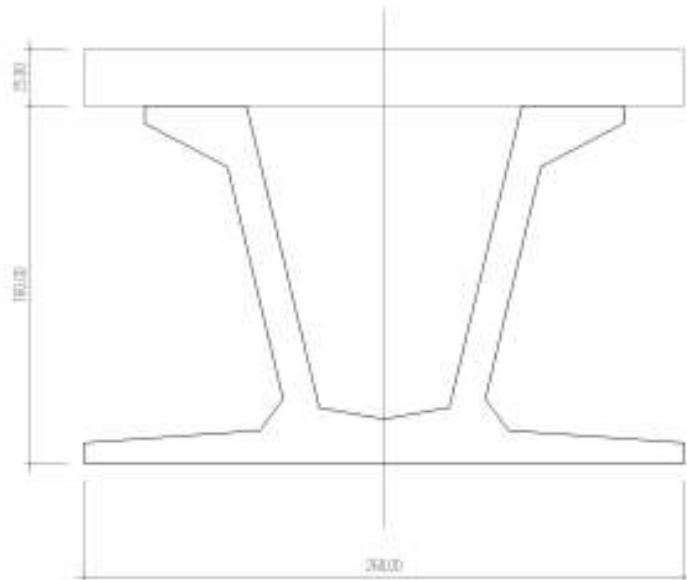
Sezione corrente della trave prefabbricata in c.a.p.
